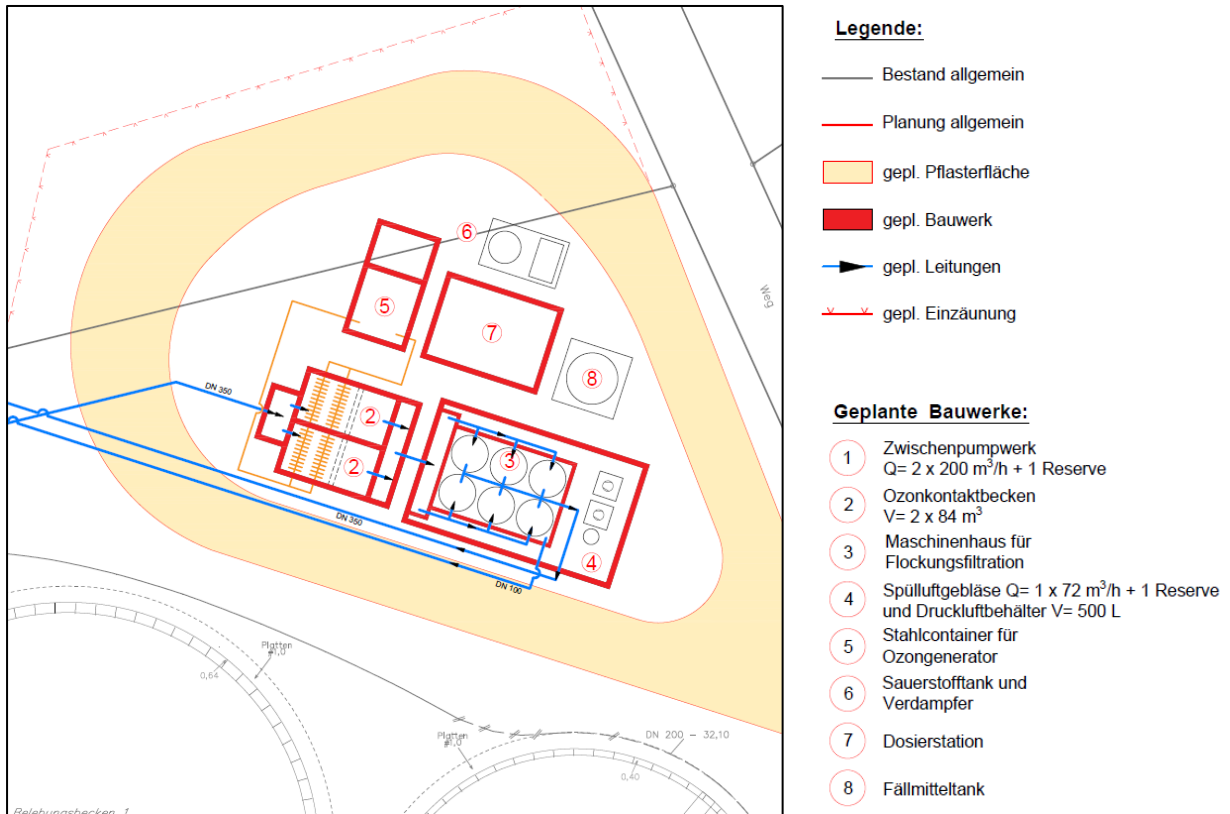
Variante 3 (Ozon), Lageplanausschnitt
